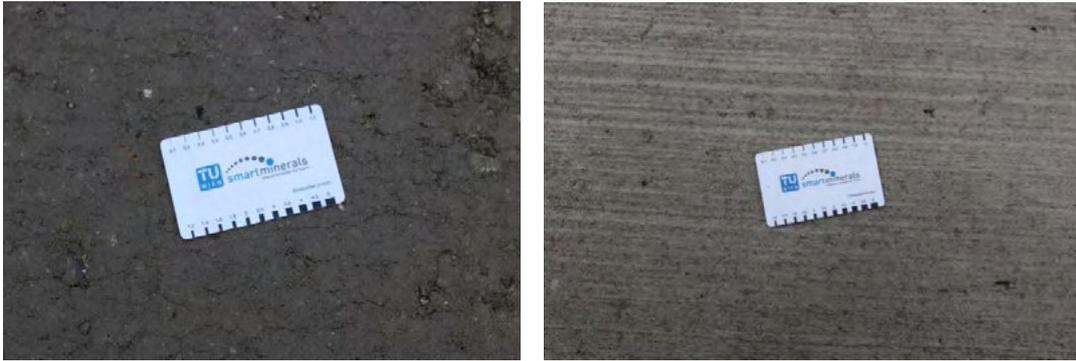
links: Betonoberfläche nach dem Walzvorgang; rechts: Oberflächentextur Besenstrich
